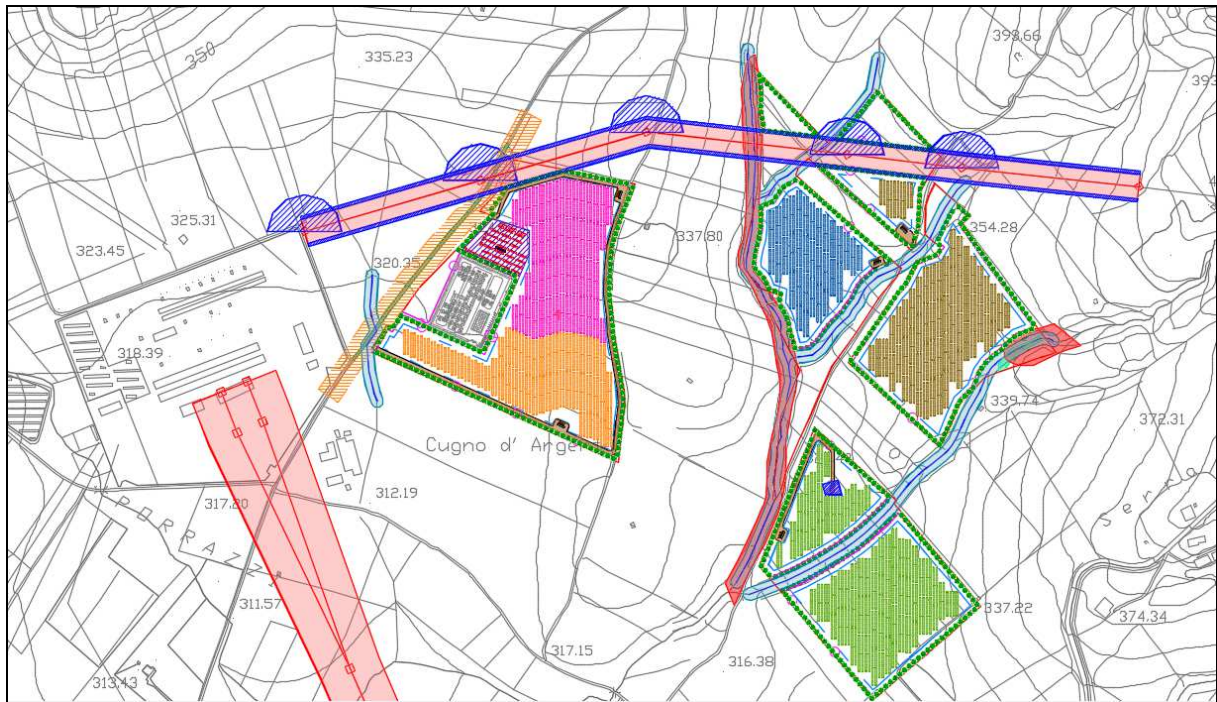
Planimetria dell'impianto fotovoltaico.
